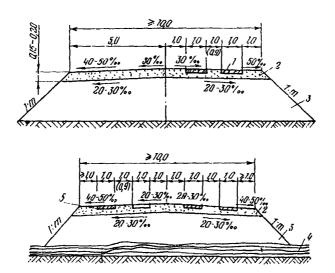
Поперечные профили двухполосных дорог со сборкым покрытием из железобетонных плит при строительстве трубопроводов диаметром до 1020 мм:
